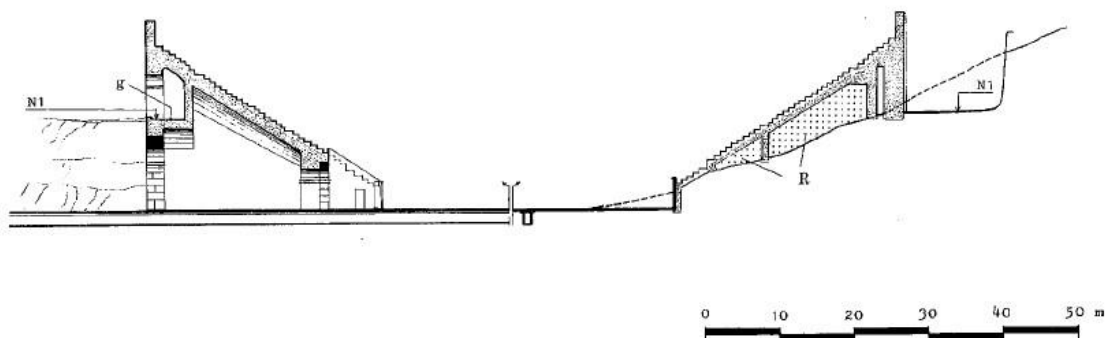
Coupe transversale du théâtre suburbain de Saintes, dans : Golvin, 1988 b, planche XXXIII
